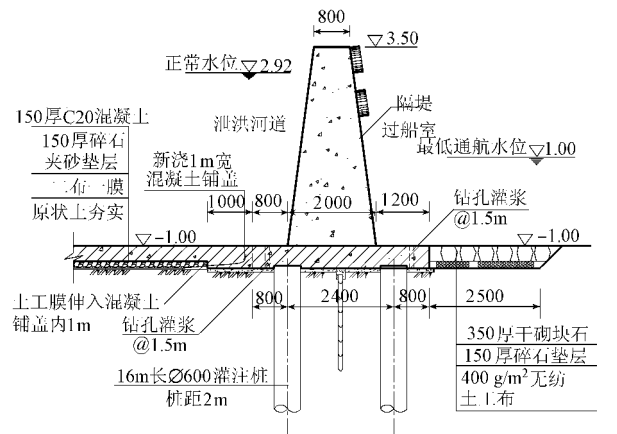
土工膜防渗方案断面(高程单位:m,尺寸单位:mm)
